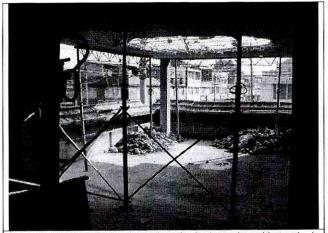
Apuntalamiento preventivo de la losa de cubierta de la vivienda. Apréciese también la demolición de un sector de la losa.
